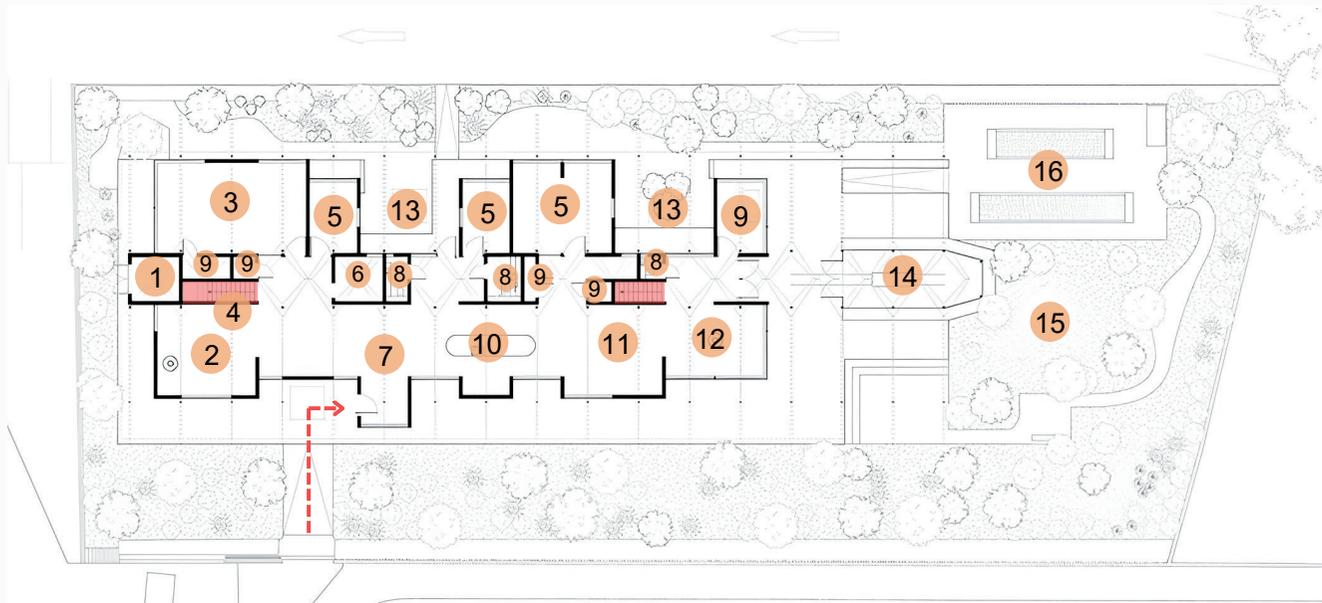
Planta Térreo - Maggie's Centre Manchester. Acesso em: Archdaily (2024).
